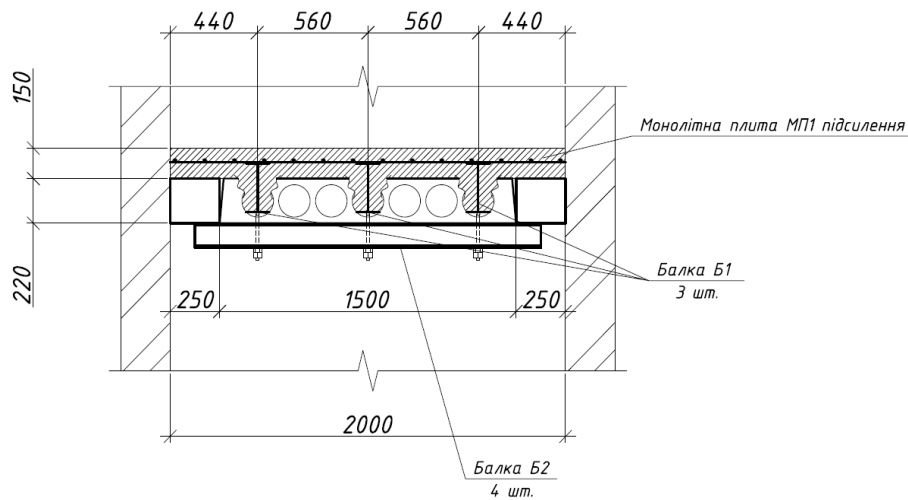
Схема підсилення конструкцій перекриття, поперечний розріз.
